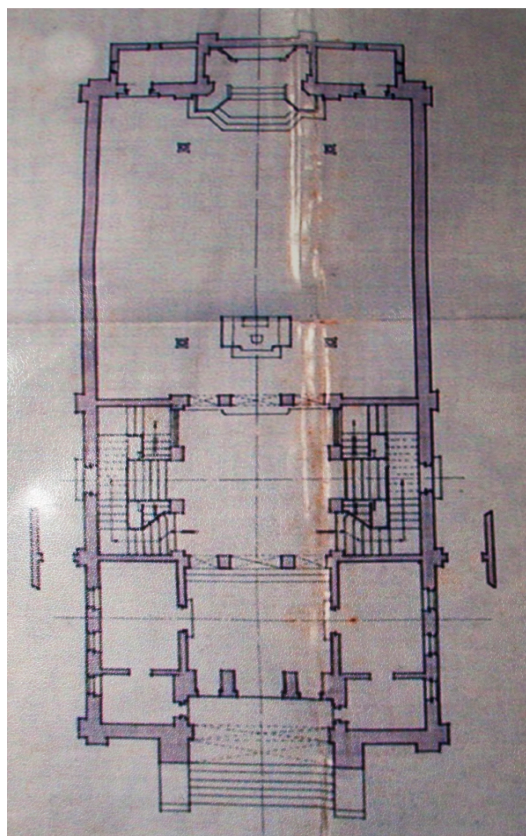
Sinagoga Mekor Haim (Porto): Planta
